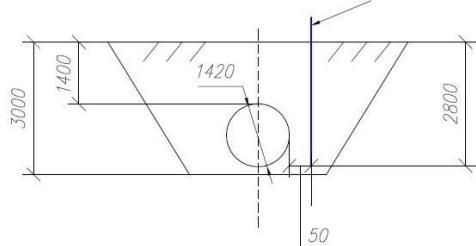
Схема размещения МЦДТ 1301 возле подземного газопровода
